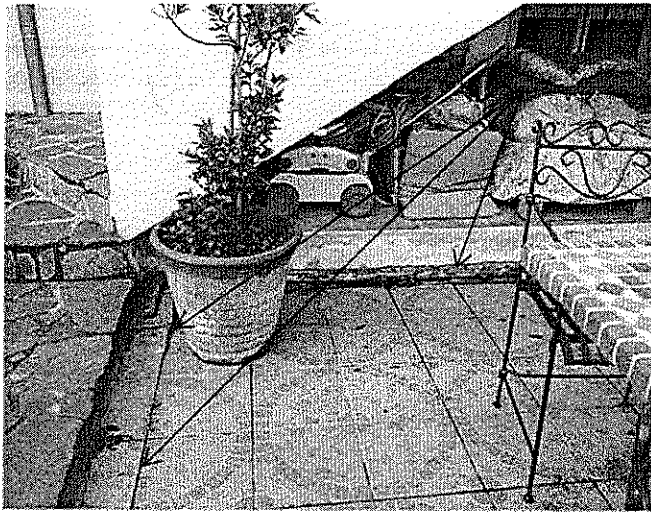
e 14 -Particolare inizio degrado di una parte Pavimentata della Corte/Giardino.
